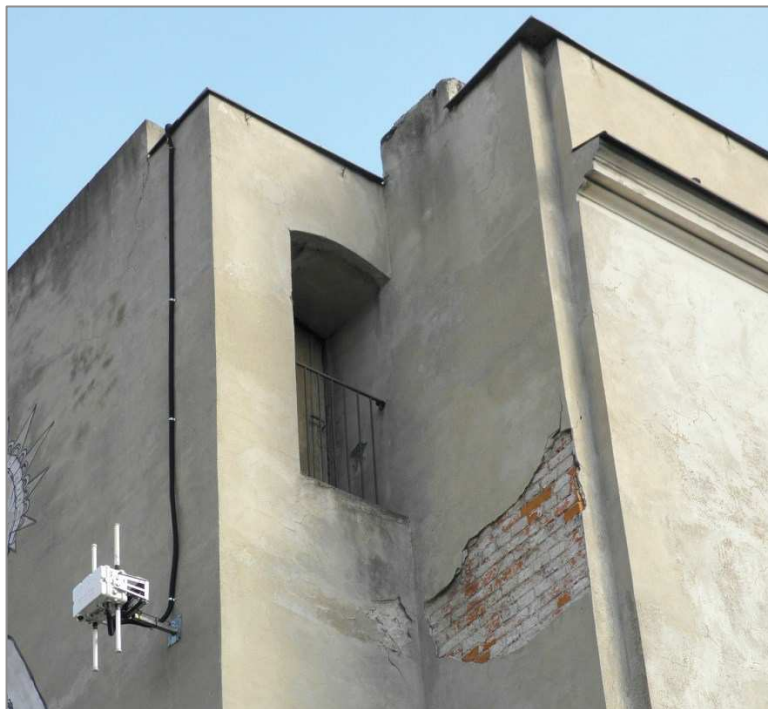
Elewacja południowa. Korozja, odspojeni e tynków przyziemia. Zawilgocenia.
